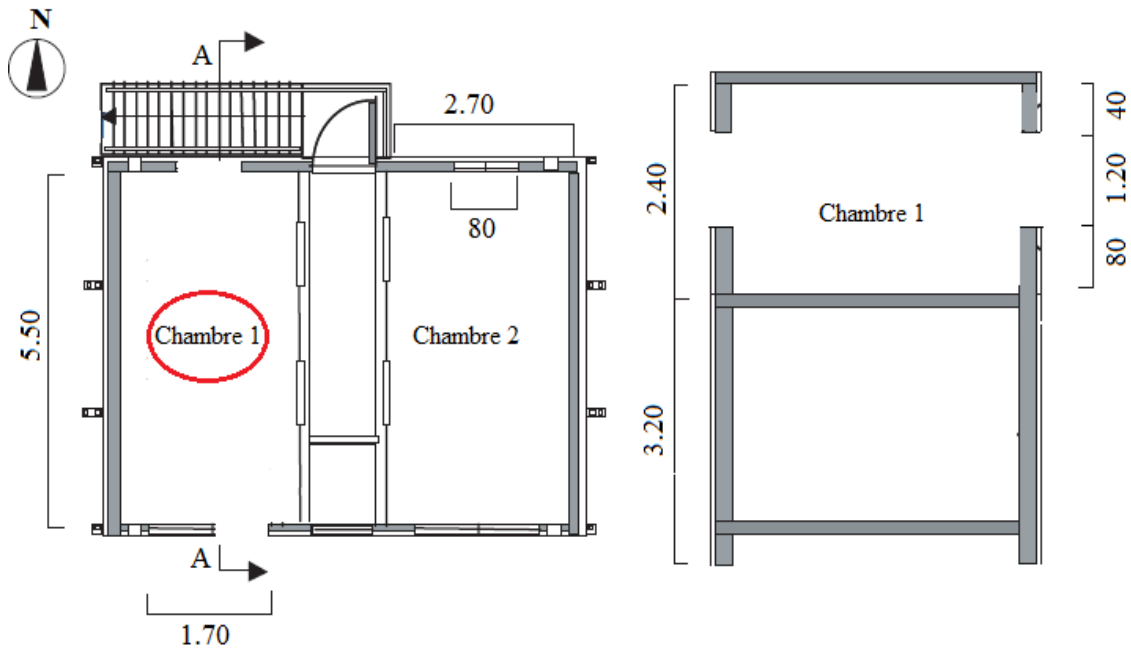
Vue en plan (à gauche) et coupe verticale (à droite) de la maison étudiée.
